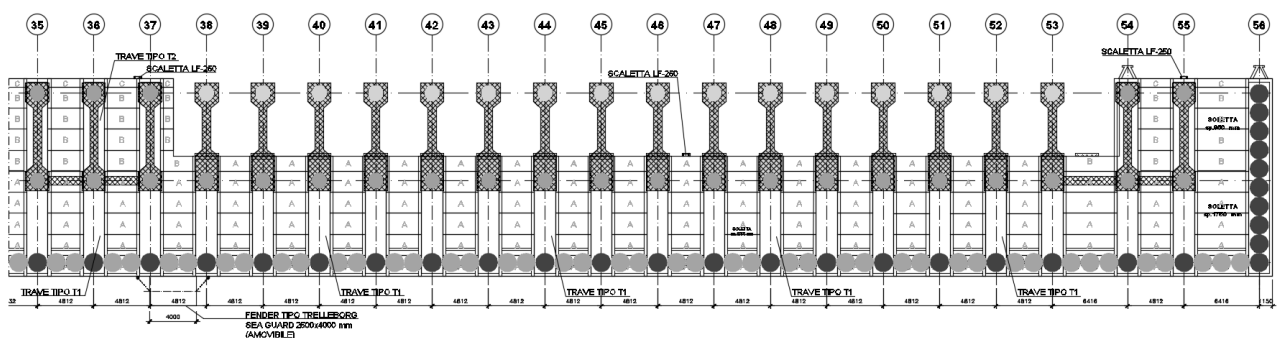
PD adeguato: Settore D – pianta fondazioni – stralcio.
